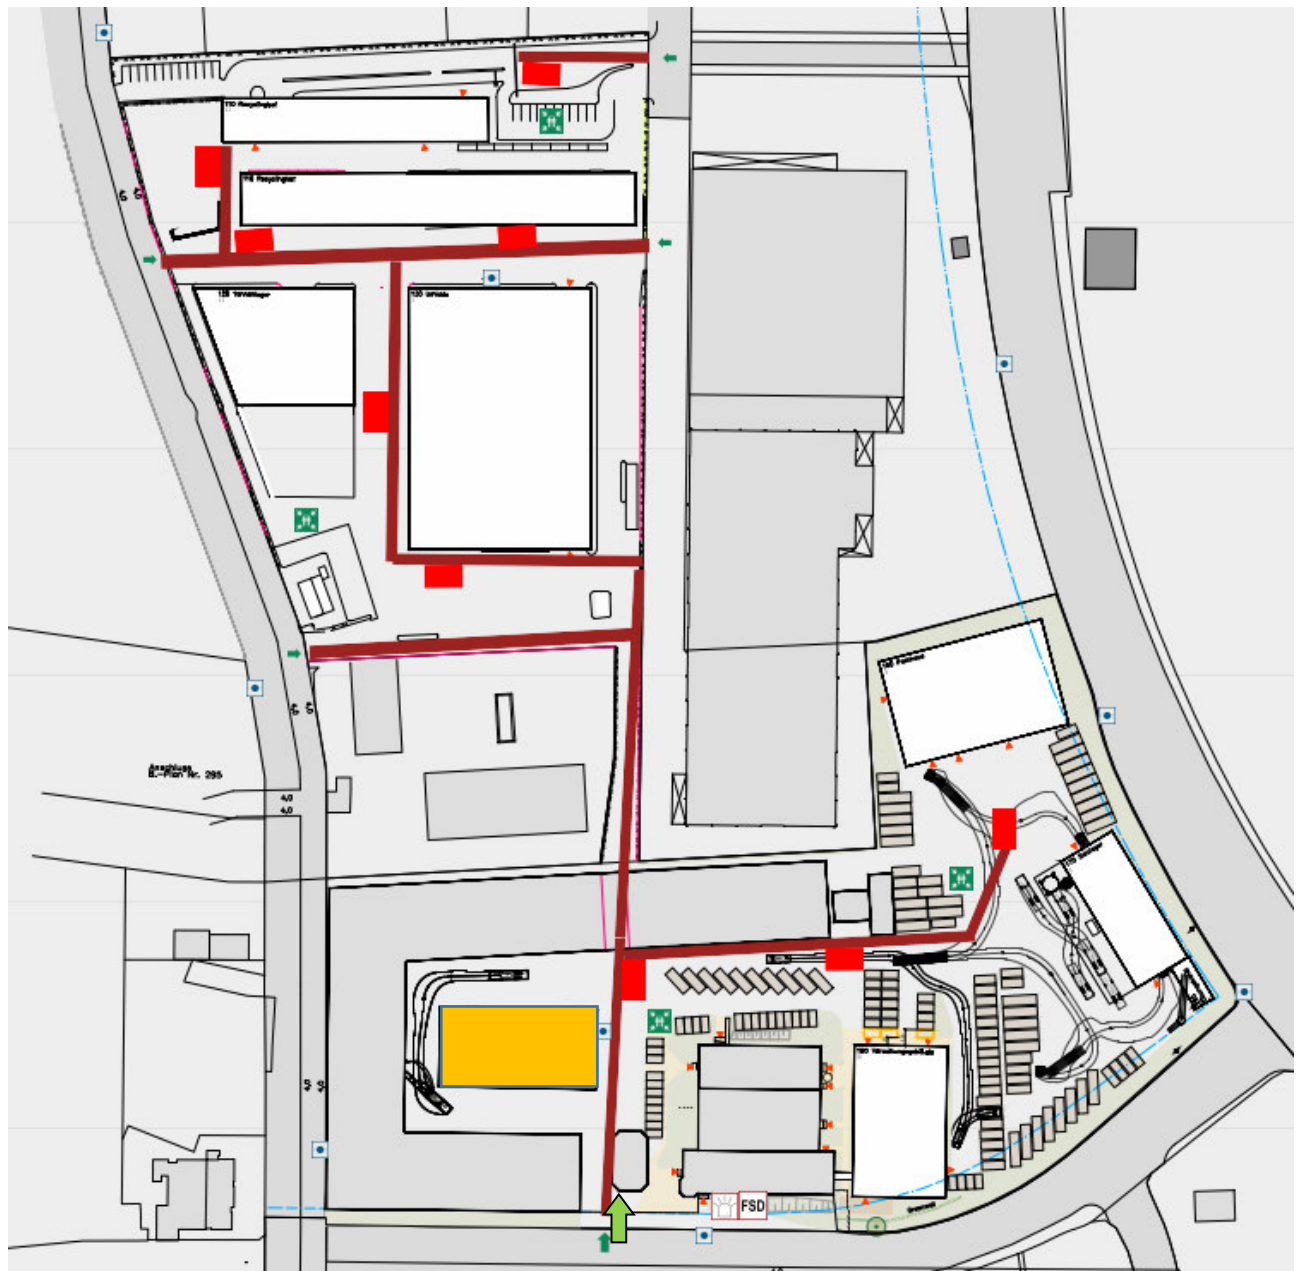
Lageplan (Quelle: Schüssler Plan)
